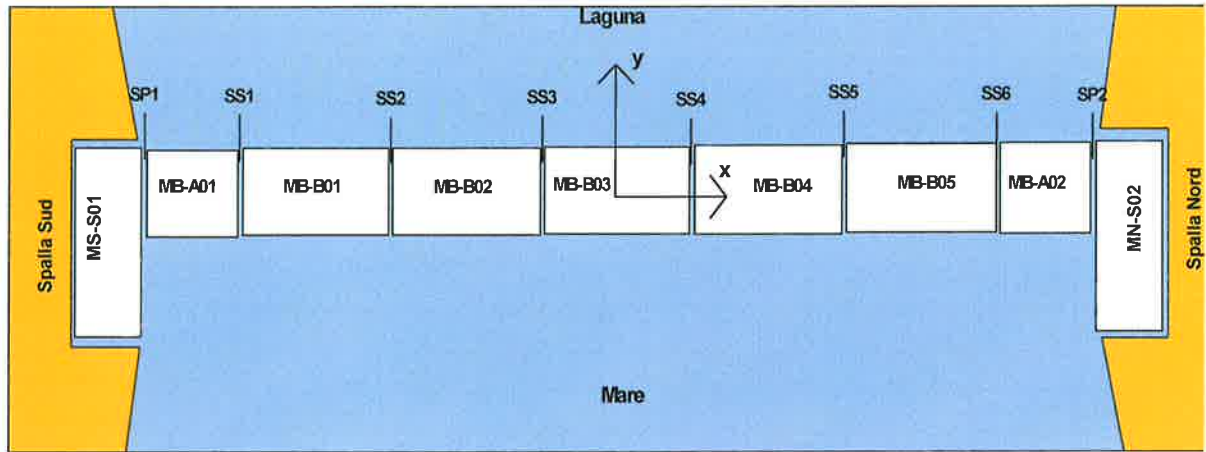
BARRIERA DI MALAMOCCO - PLANIMETRIA
